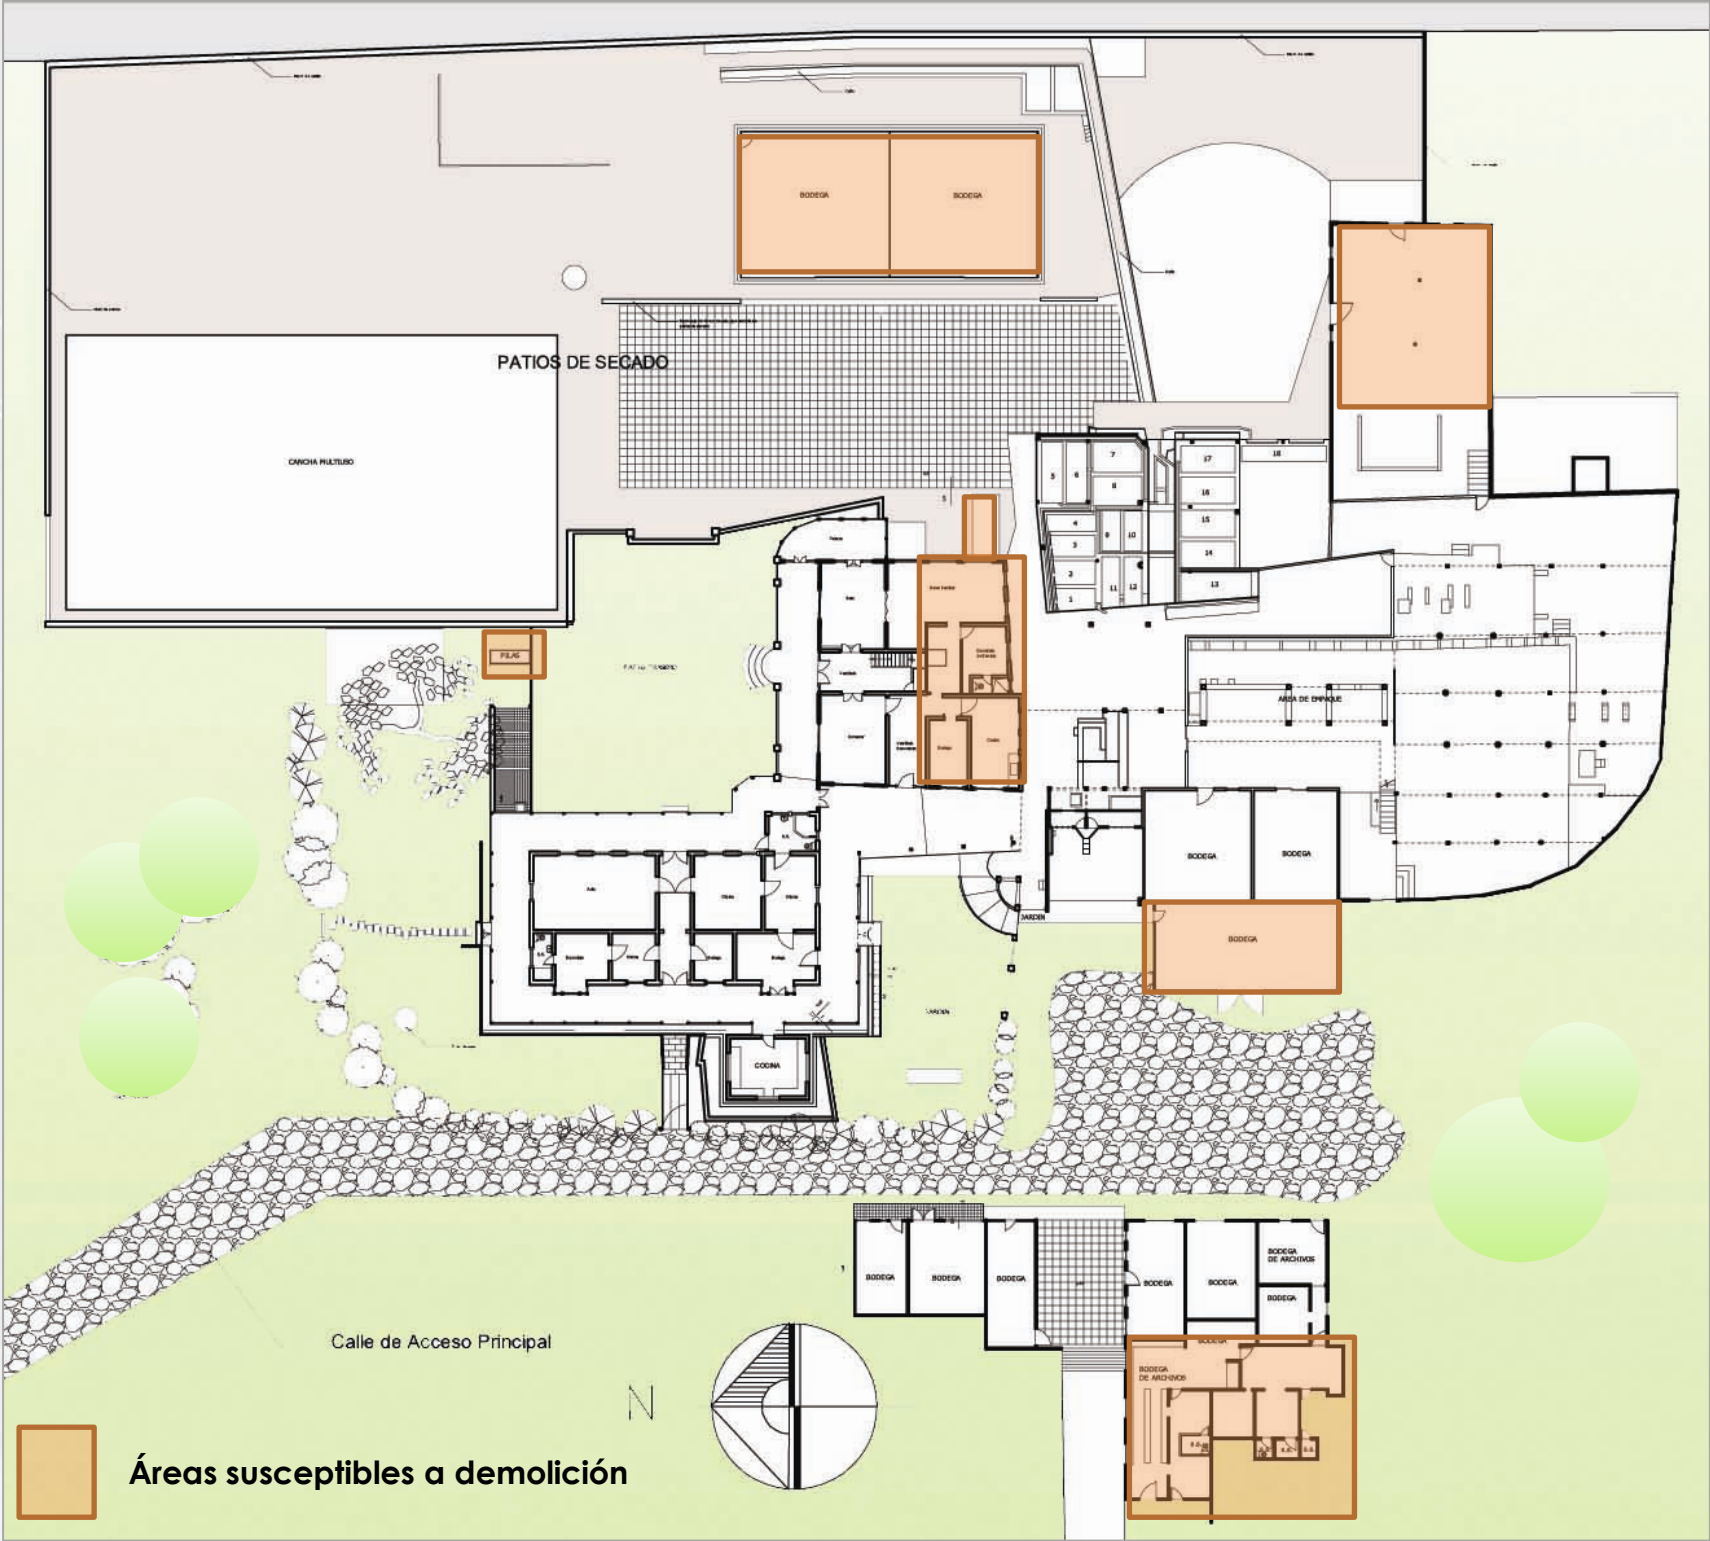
Planta de distribución de las áreas susceptibles a demolición.
